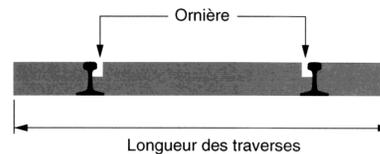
Dimensions de la surface de croisement des passages à niveau - coupe transversale
